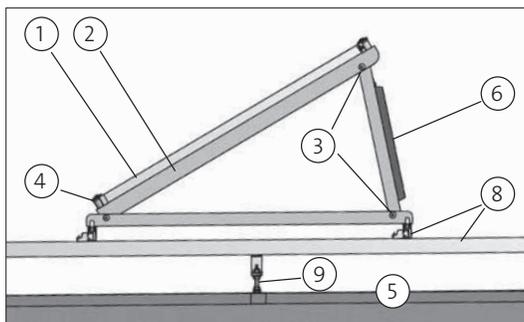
Vista lateral del marco de tejado plano tipo A
